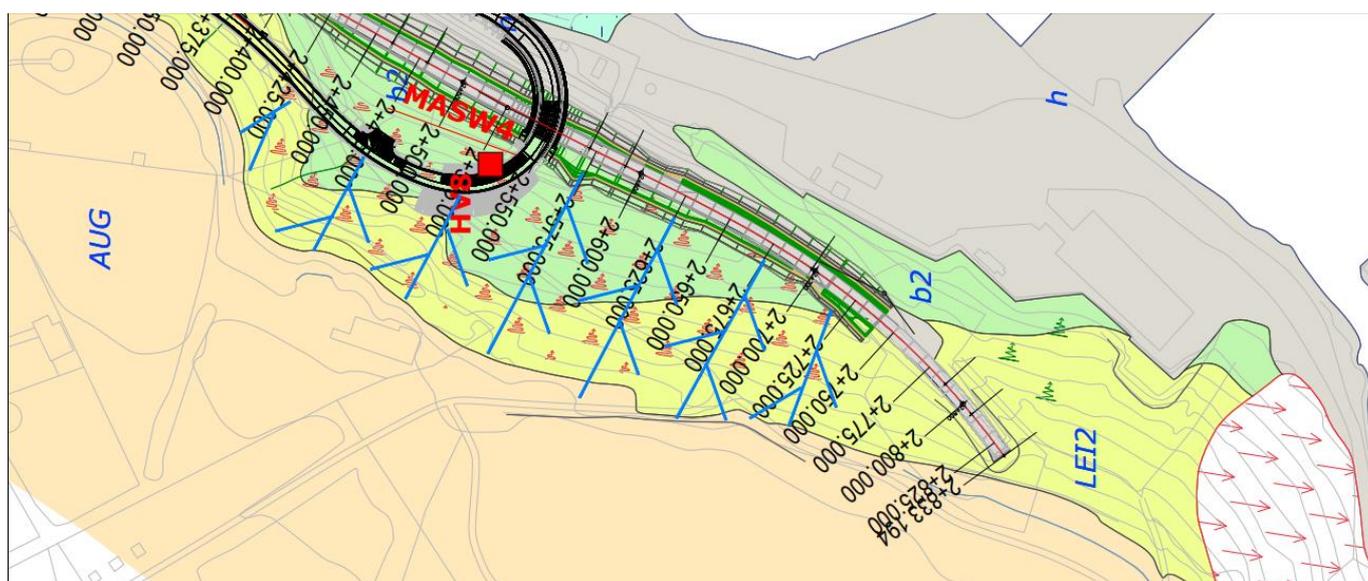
Ubicazione delle trincee drenanti previste per la stabilizzazione dei versanti soggetti a dissesti
